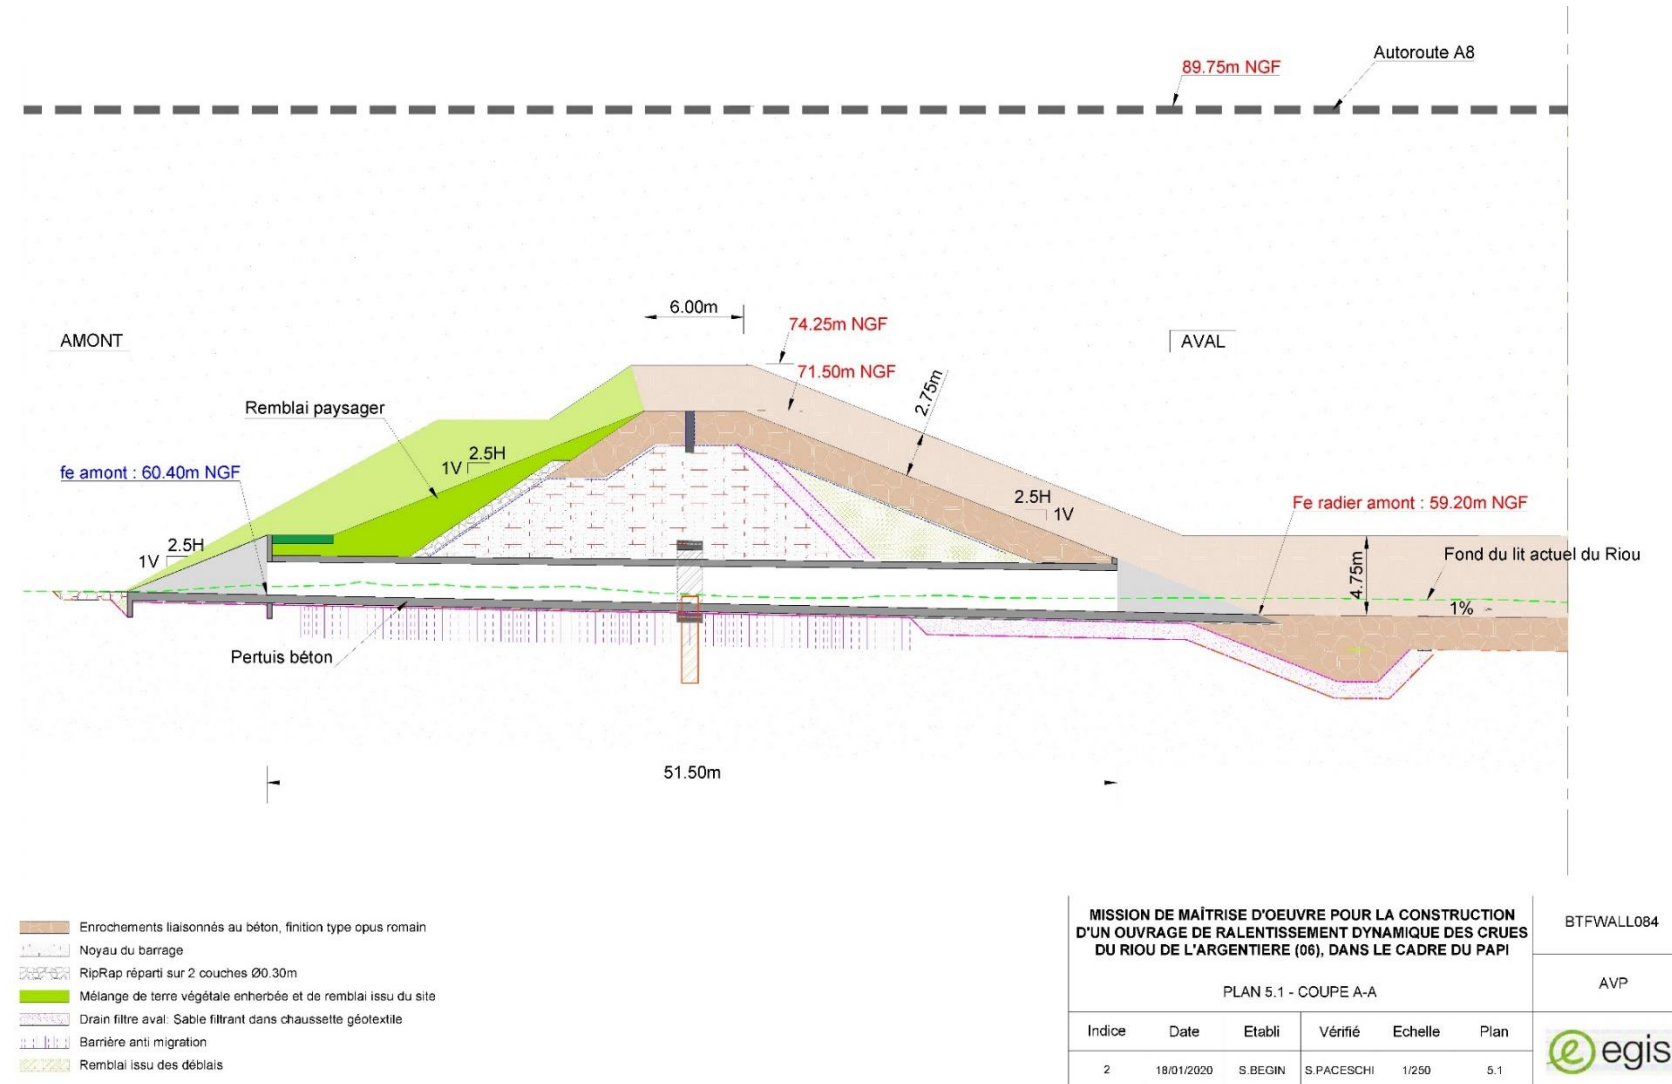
Coupe en long A A' et structure de l'ouvrage
